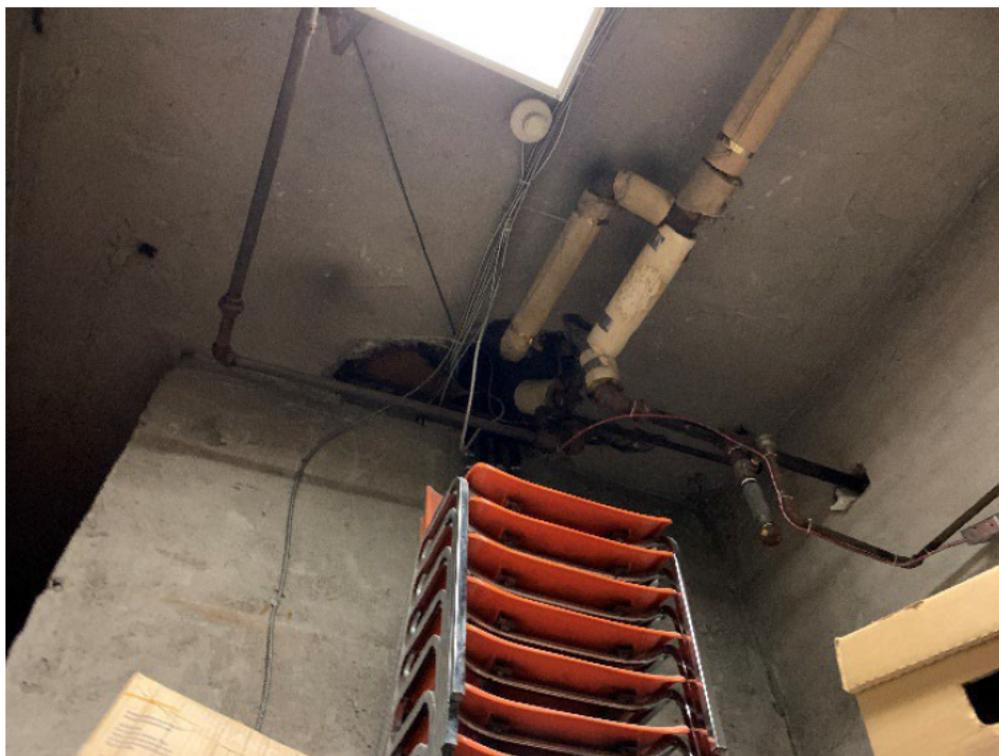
Exemple de dalles évidées de béton préfabriqué sectionnées sans renfort
